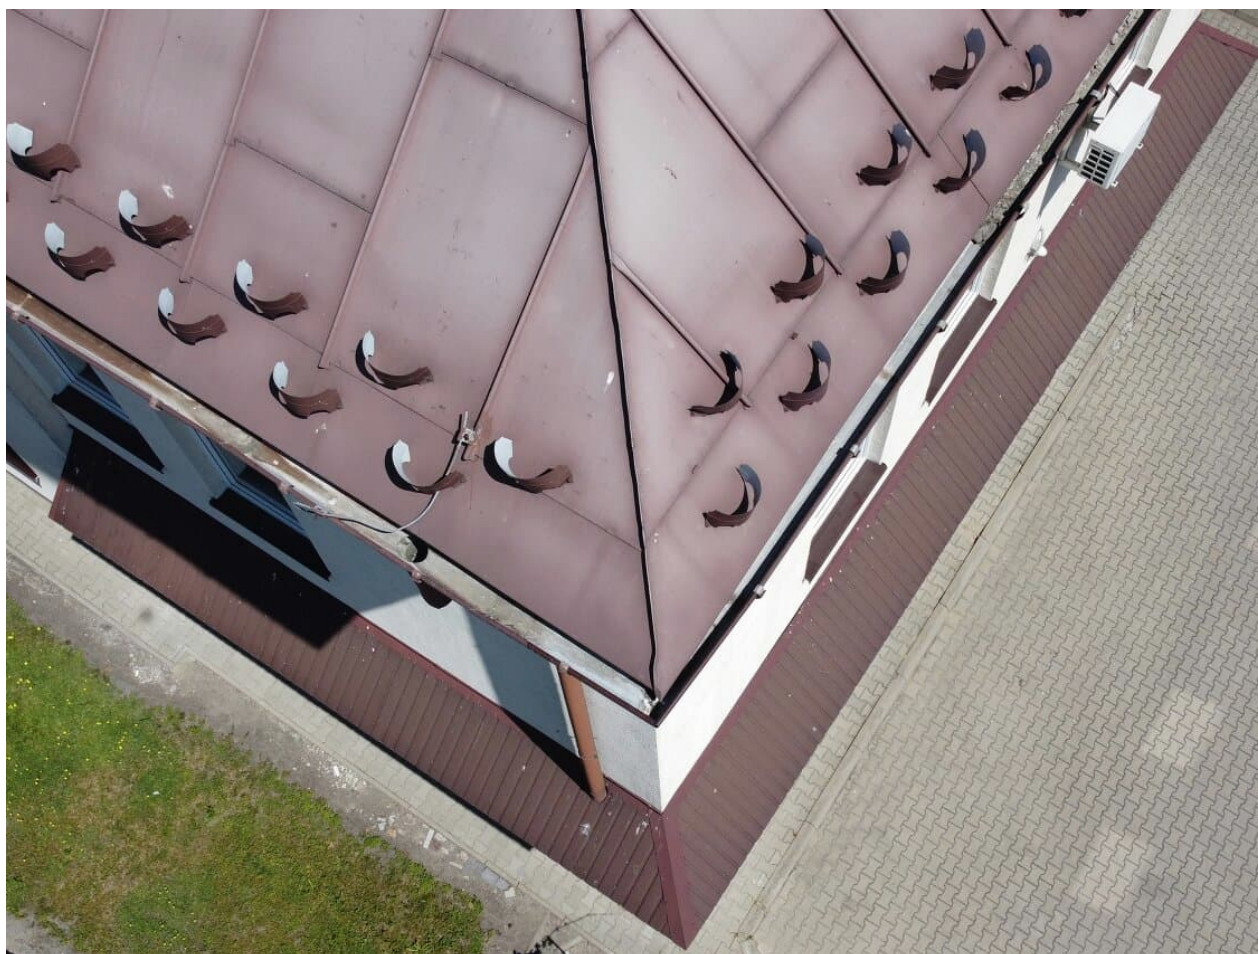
Fragment elewacji południowo-zachodniej. Strzałką zaznaczono miejsce, gdzie w pomieszczeniu na II piętrze występuje przeciek.
